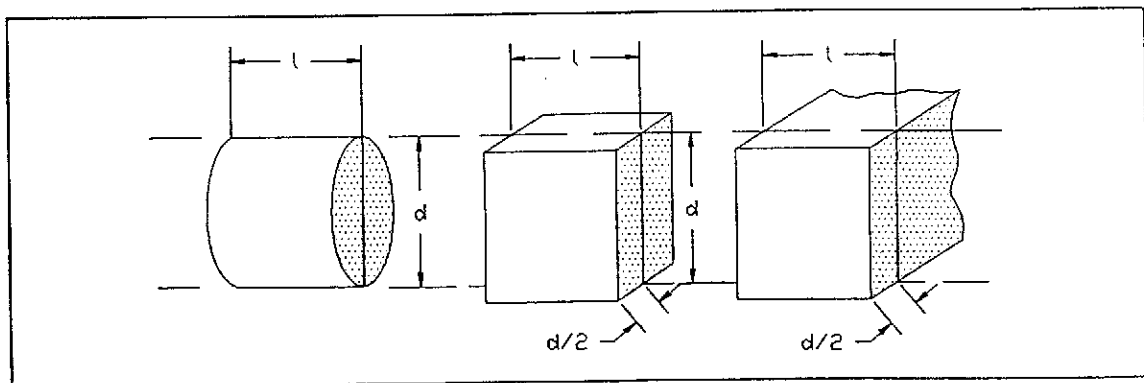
Dimensiones de las probetas para el ensayo Brasileño.
